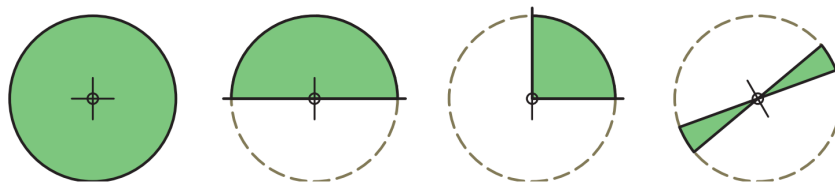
Geometrías habituales Jet Grouting – Soilcrete®.
